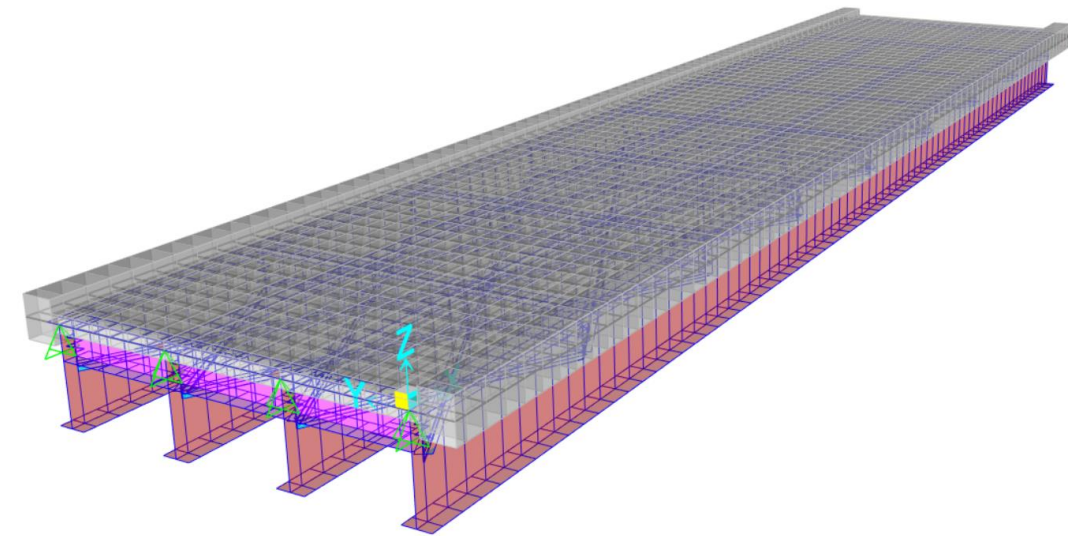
Vista 3D tipo extruido del modelo. Elaboración propia con SAP2000.
